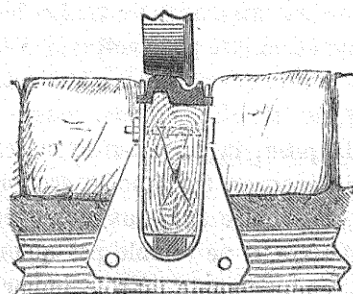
Tramways de Versailles. Section du rail, etc. Système Francq. Échelle 1/8.
